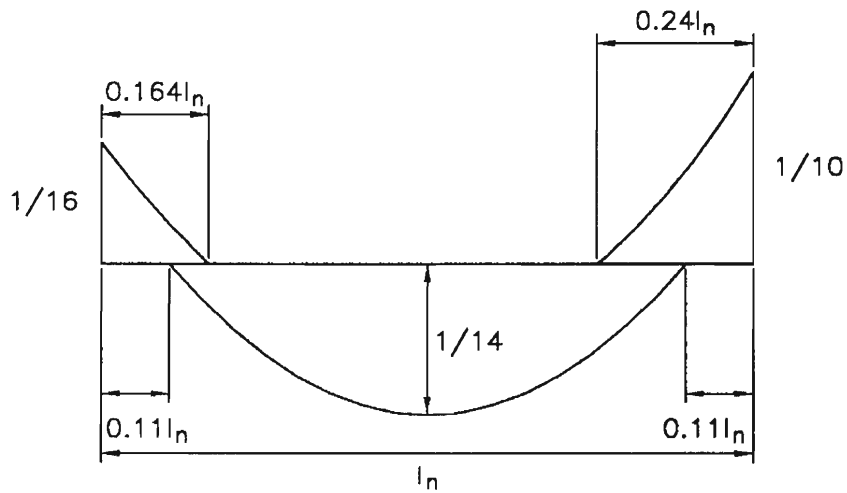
Corte del refuerzo en tramo exterior de elemento continuo con apoyo exterior solidario provisto por columna
